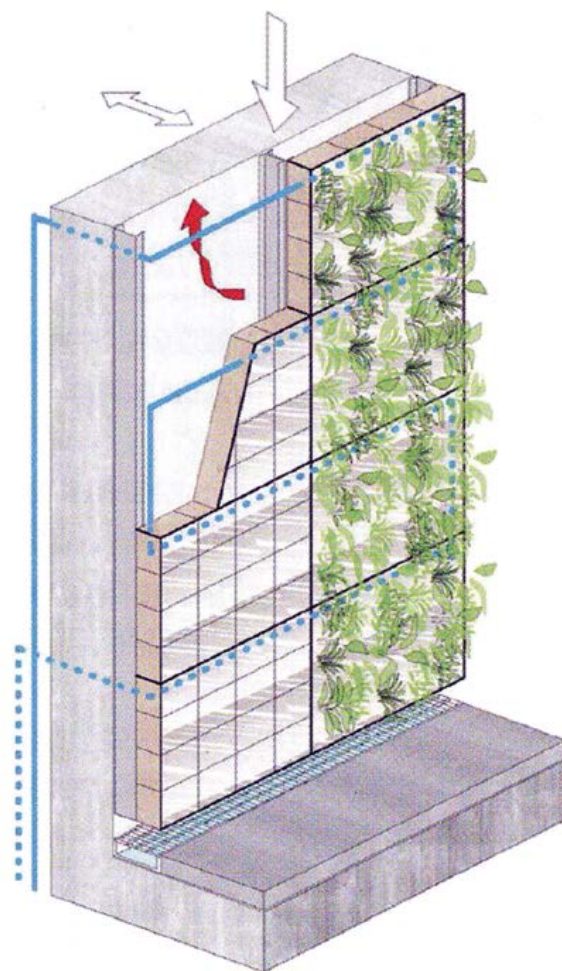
Schema - Fassadengebundenen Begrünungssystem mit Modulen
